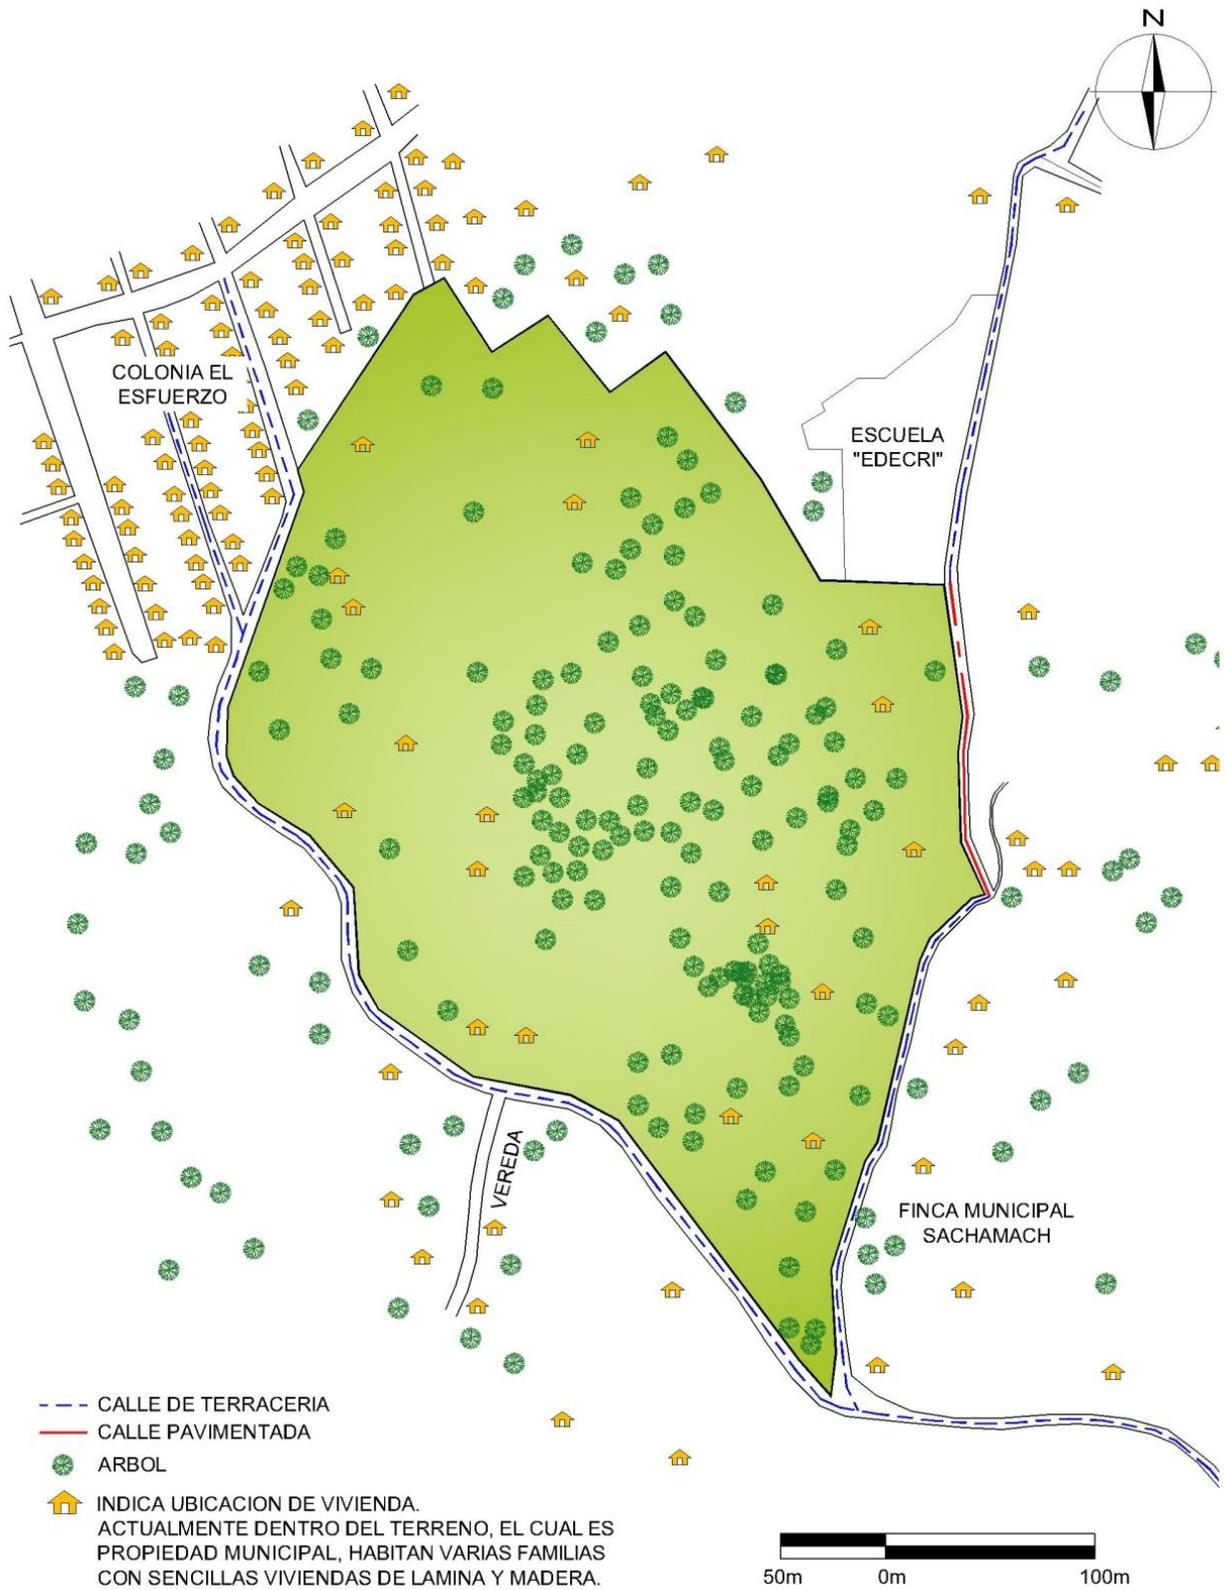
Plano de estado actual del terreno. Fuente: elaborado por M. Ochoa Morales.
